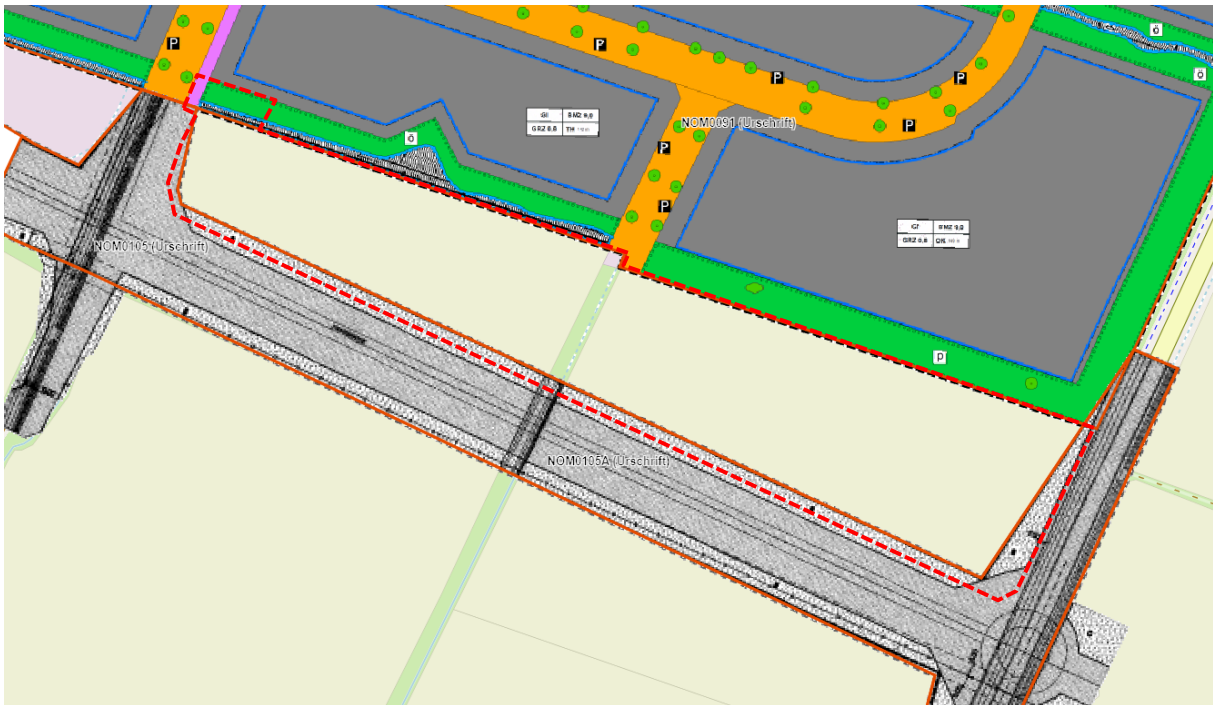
Lage des Plangebietes im Kontext der benachbarten Bebauungspläne NOM Nr. 91 und Nr. 105 A (Stadt Northeim - Geoportal Bauleitplanung, 2023, ohne Maßstab, genordet)
